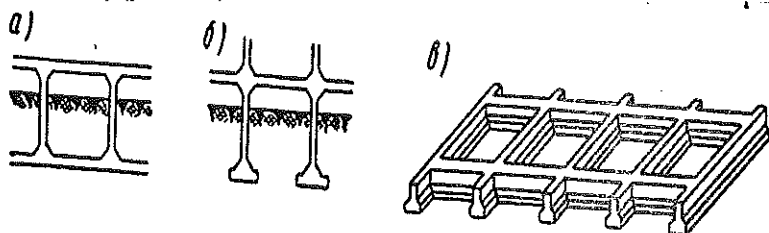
Схемы фундаментов, адаптированных к восприятию неравномерной осадки оснований: а), б) - рамные; в) – в виде перекрестных лент
